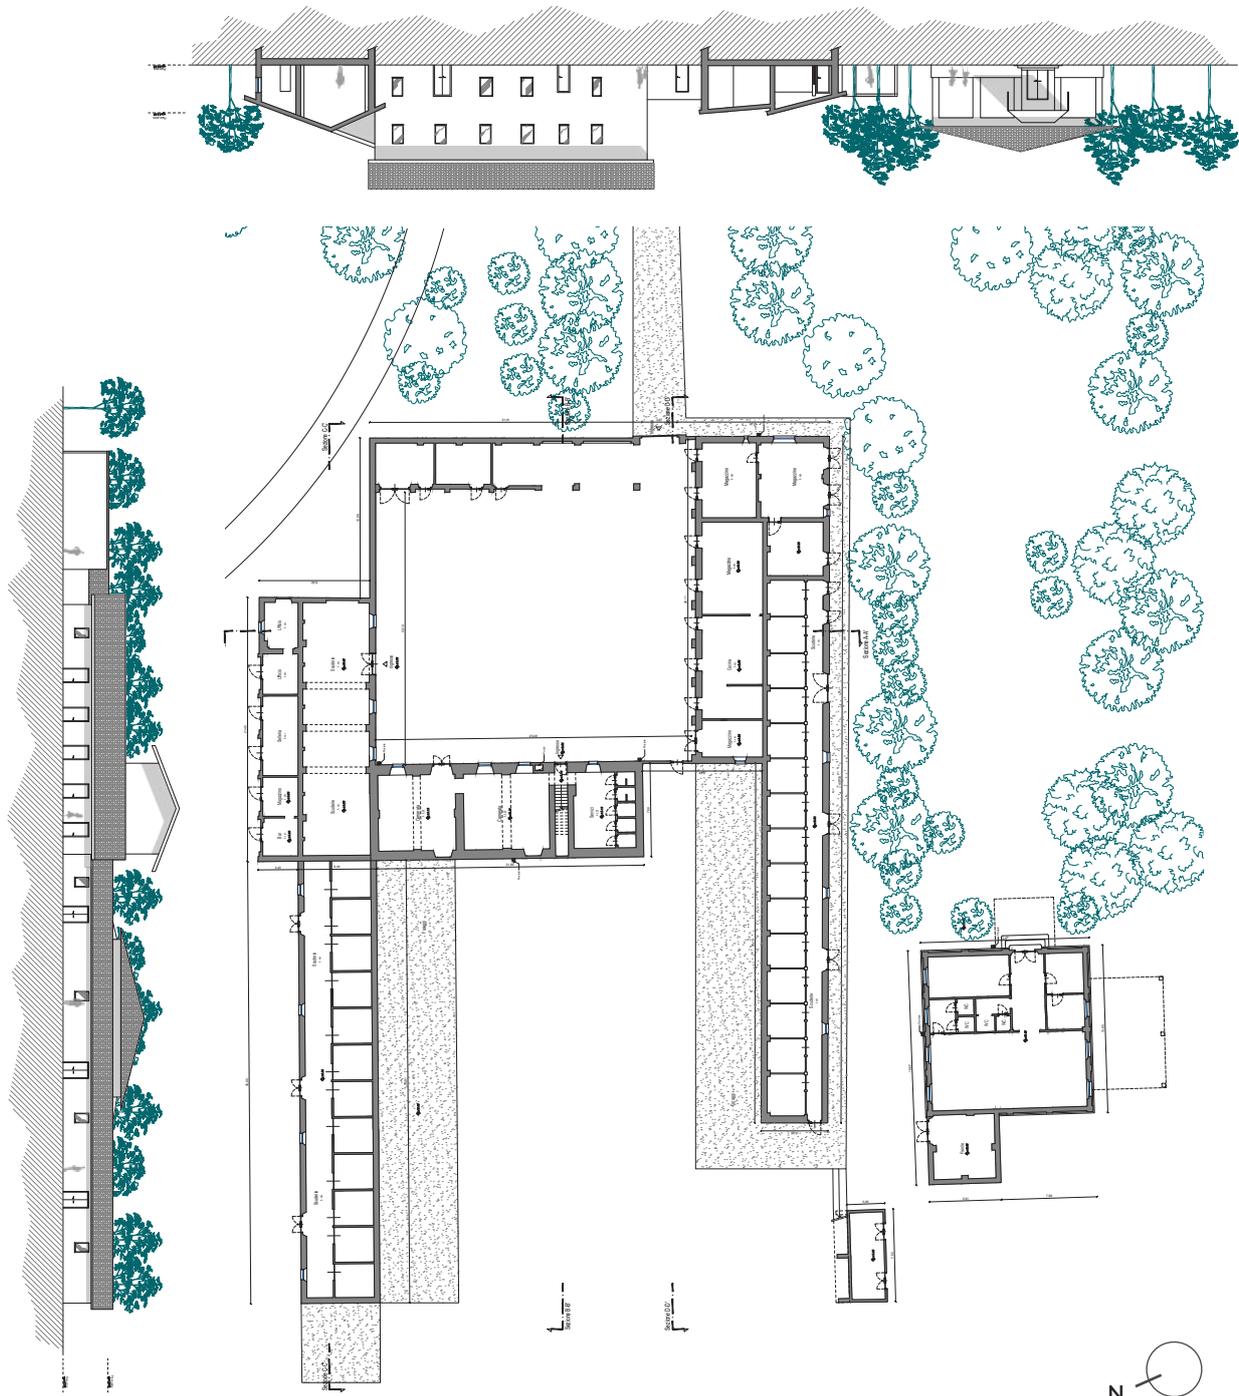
Planimetria generale area Ex-galoppatoio Meisino.
